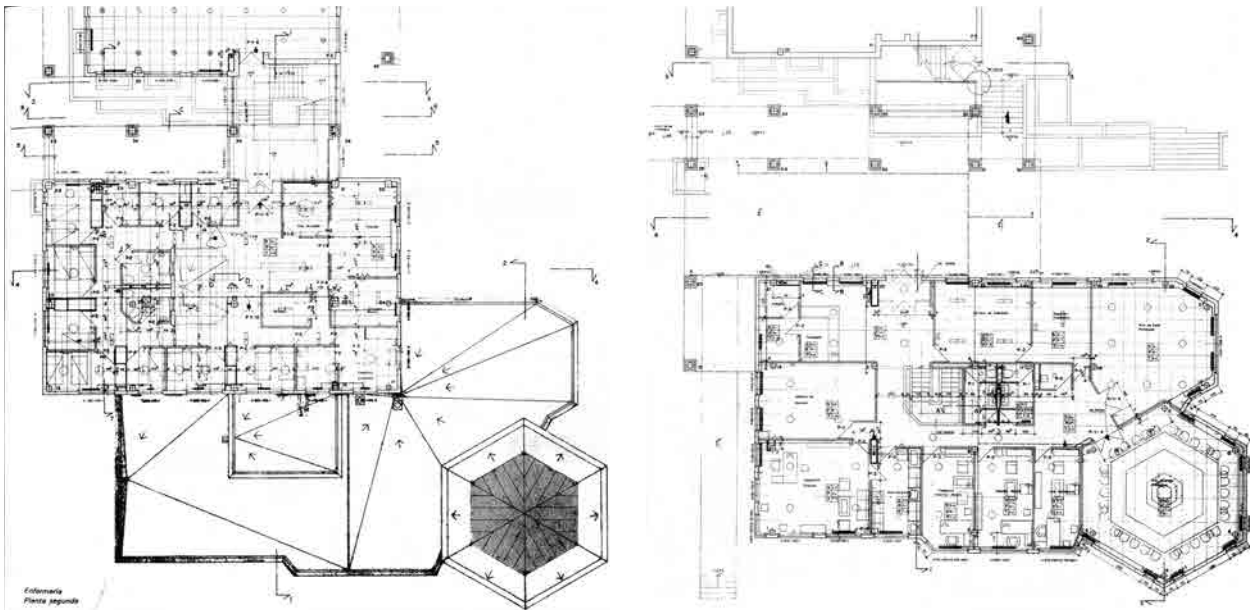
y Fig. 42 Edificio de dirección-administración y enfermería. Planta de la zona de enfermería (izquierda) y planta de la zona de dirección (derecha).
